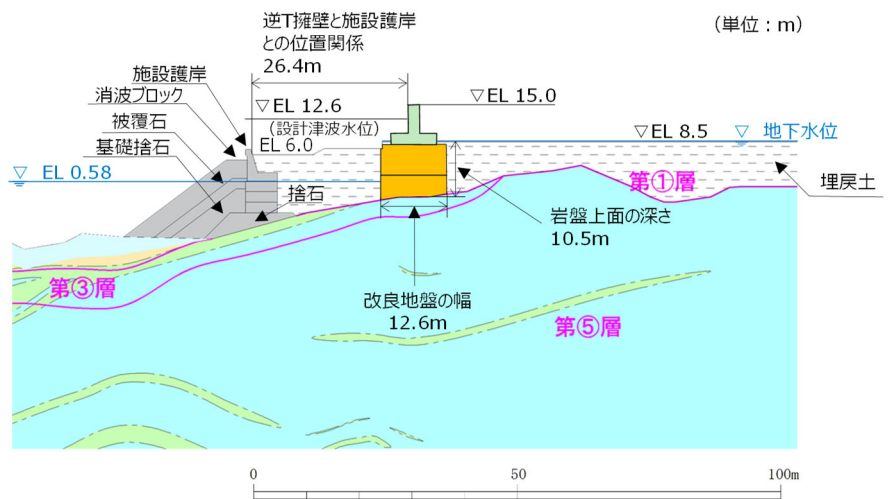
防波壁（逆T擁壁）の横断面図（②-②断面）
